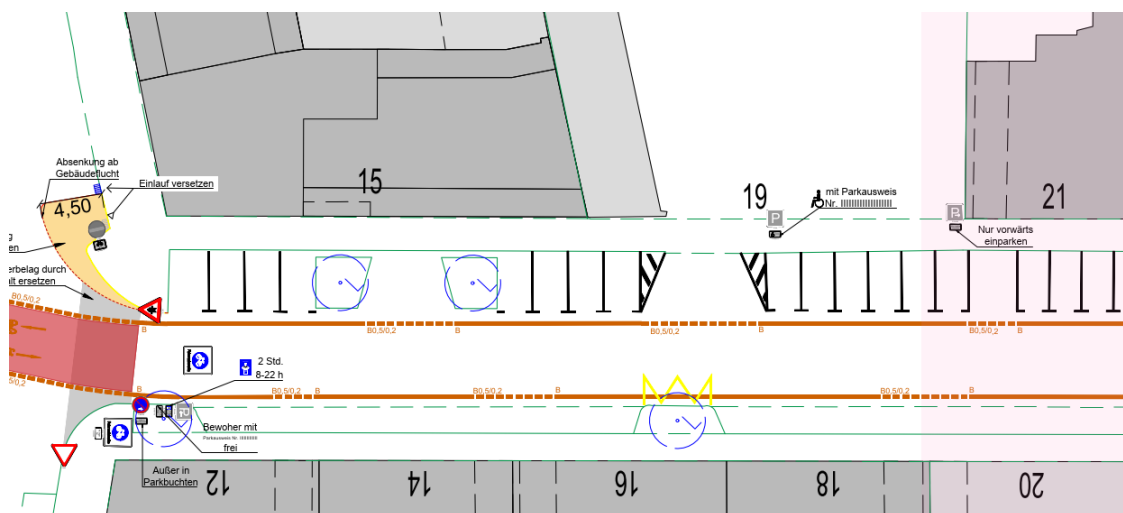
Parkstände und Baumpflanzungen beeinträchtigen die Sicht der Kfz-Führenden aus den Grundstückszufahrten (Plan 1)
